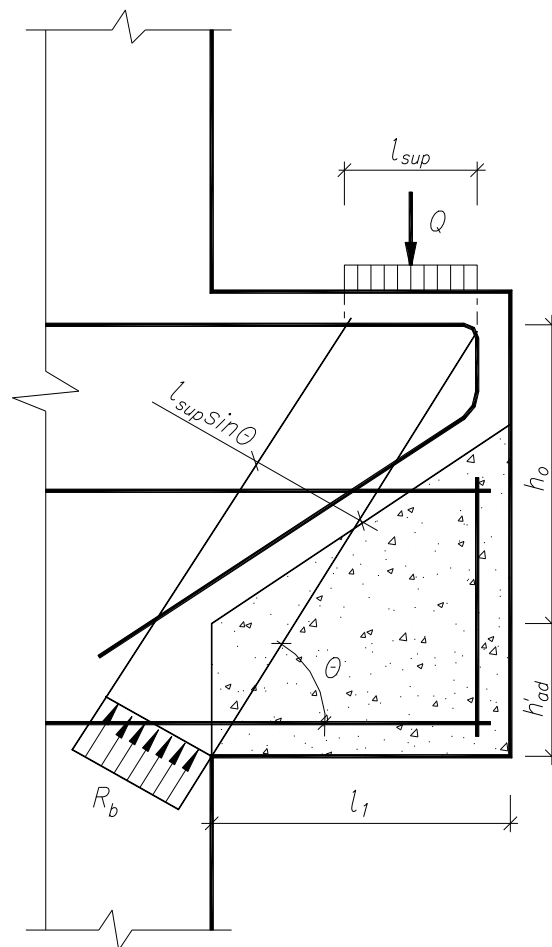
Расчетная схема короткой консоли при усилении наращиванием на действие поперечной силы
